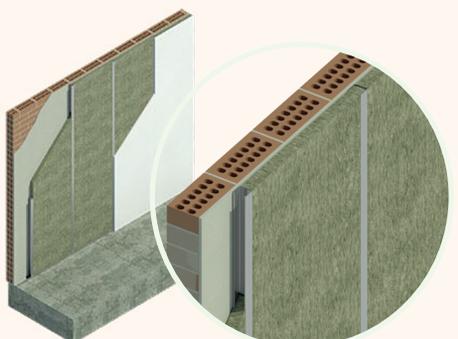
Interrupción del aislamiento térmico de la cámara con la periferia metálica en una fachada con trasdosados de entramado autoportante
